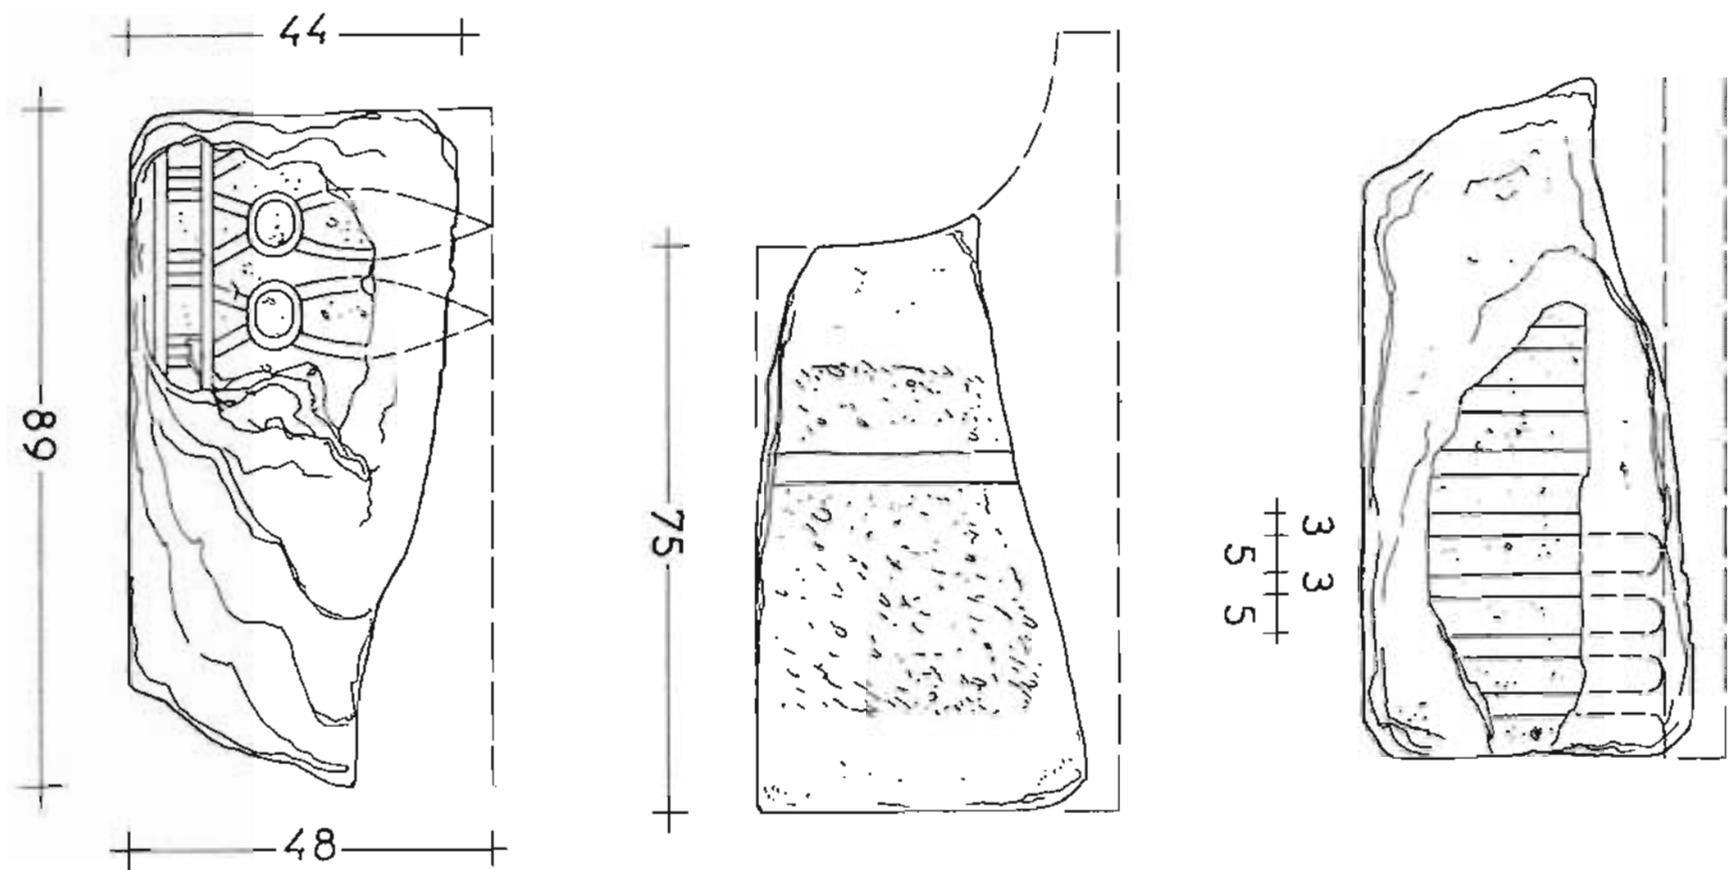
Bloc de couronnement 658, prenant place sur le mur du sanctuaire.
